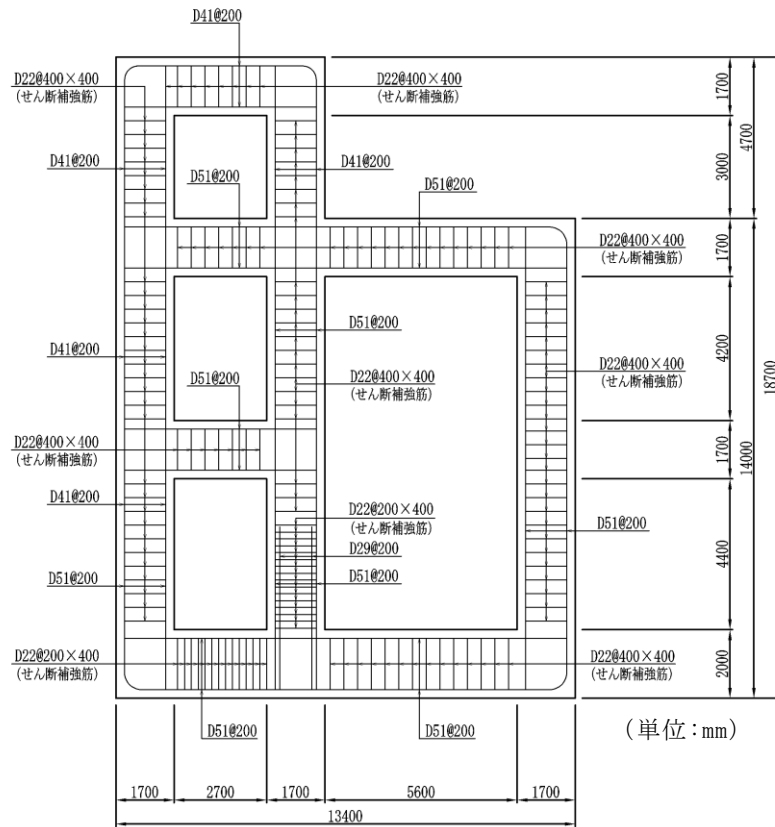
第 1 ベントフィルタ格納槽 概略配筋図 (A-A 断面)
